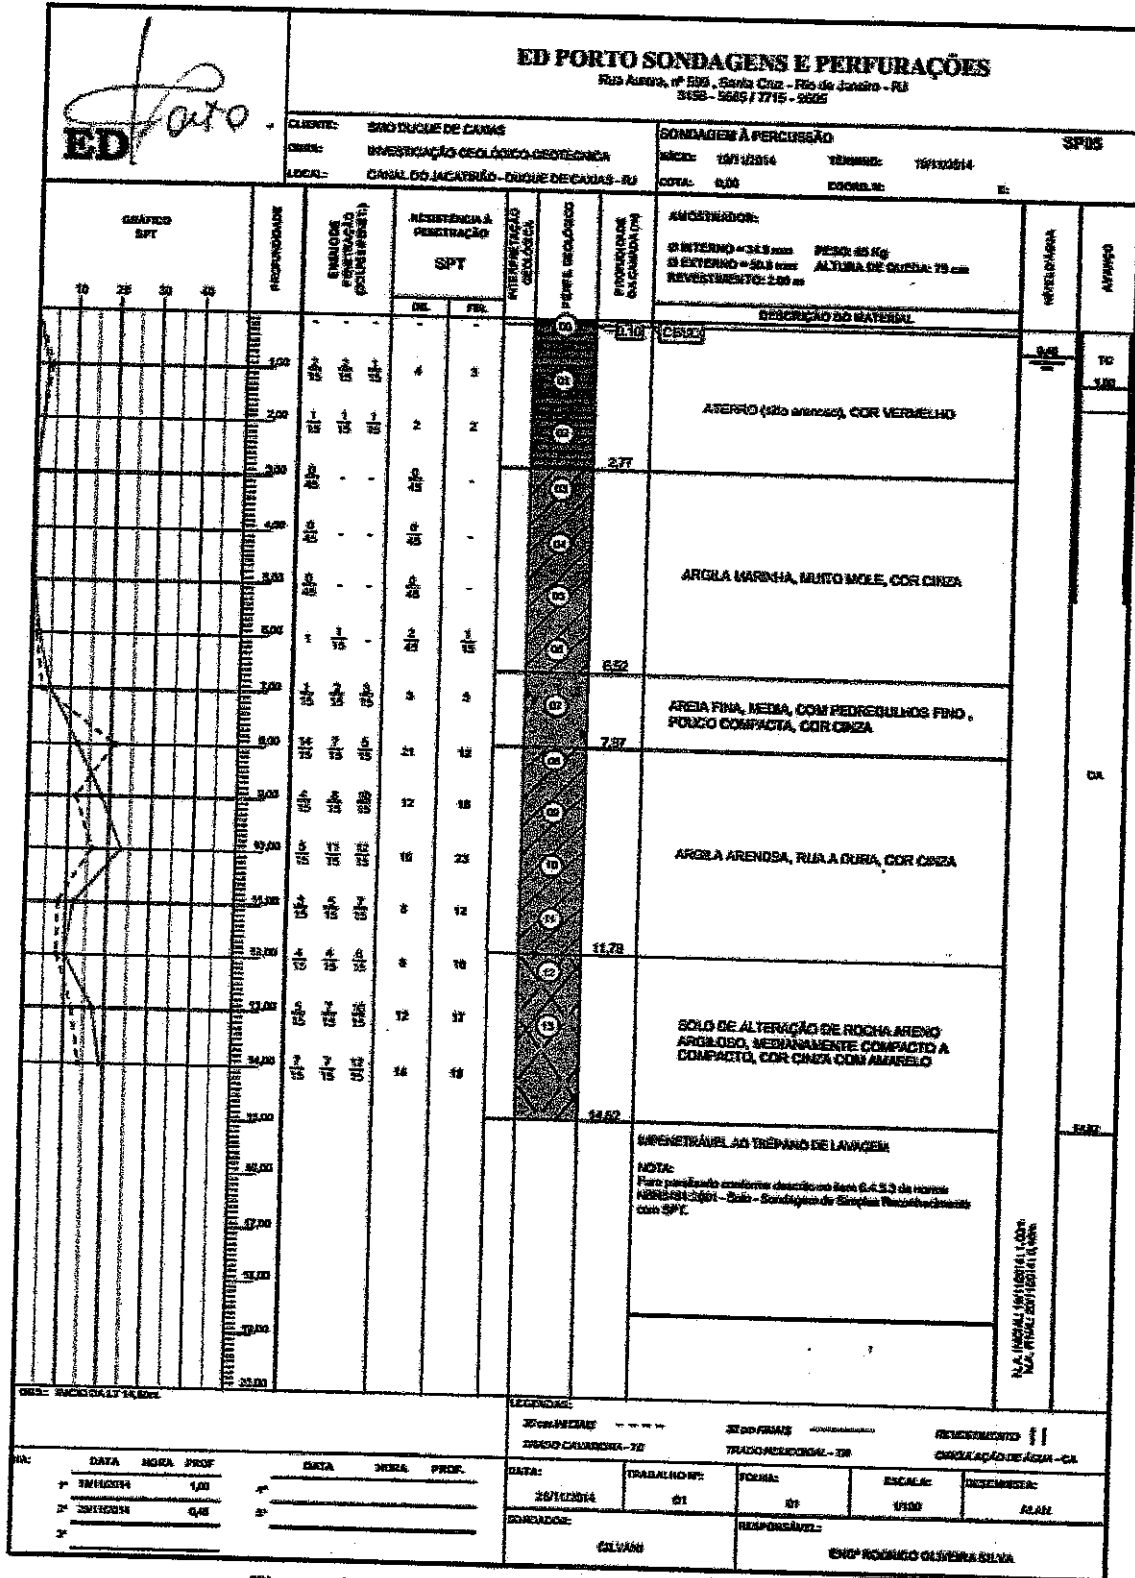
Perfil de sondagem SP-05 (Parte 1/1)
